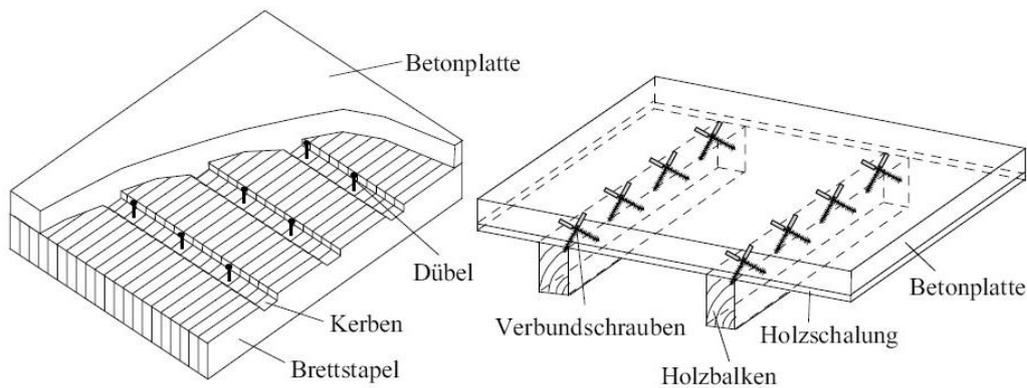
Aufbau einer Holz-Beton-Verbunddecke [34]
